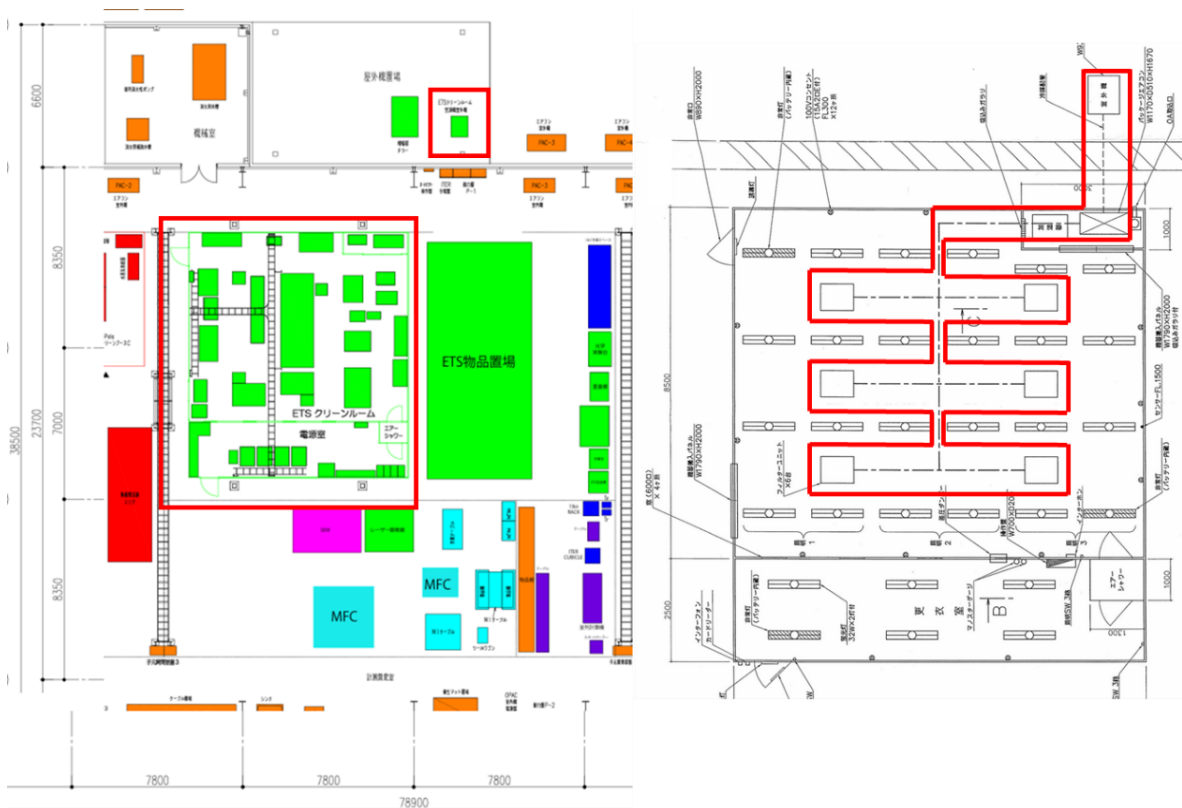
先進計測開発棟平面図及び ETS クリーンルーム平面図
